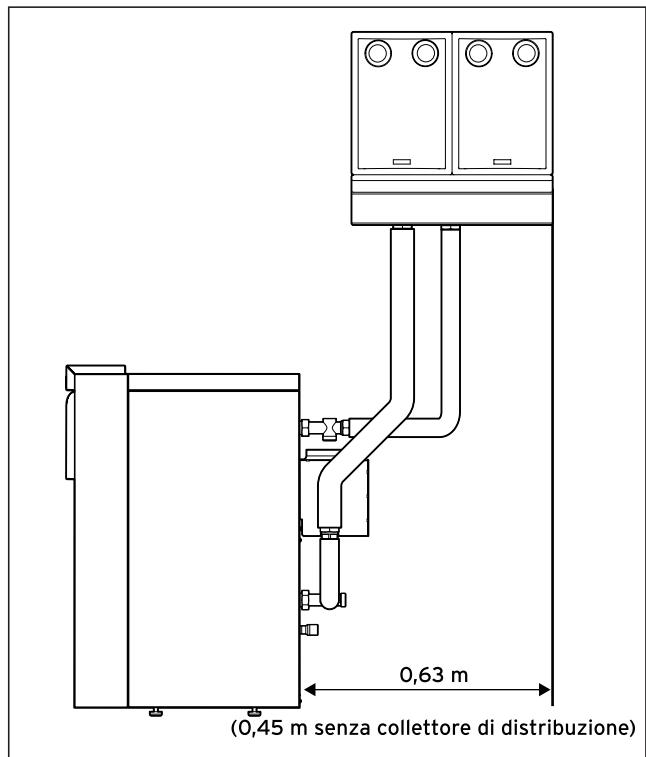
atmoVIT exclusiv con 2 circuiti di riscaldamento, installati parallelamente rispetto alla parete laterale
